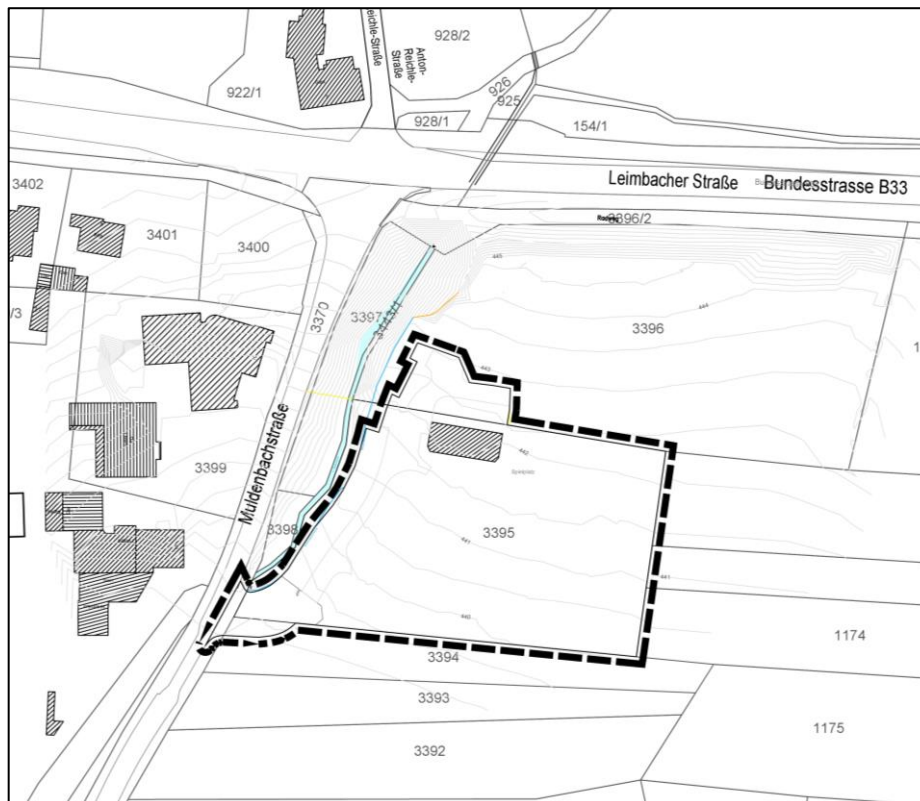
Lageplan mit räumlichem Geltungsbereich, o.M.
